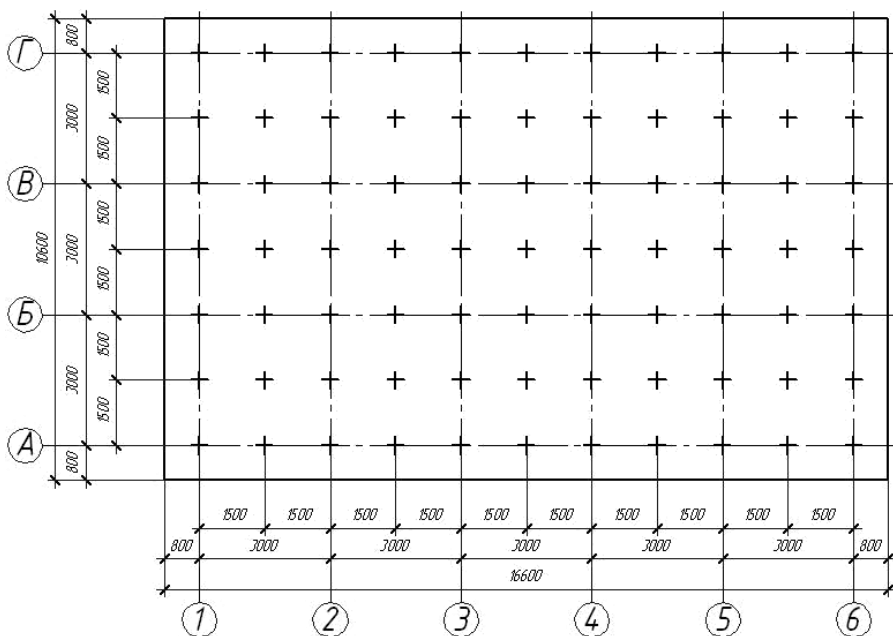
Схема розміщення палей під суцільну фундаментну плиту.
